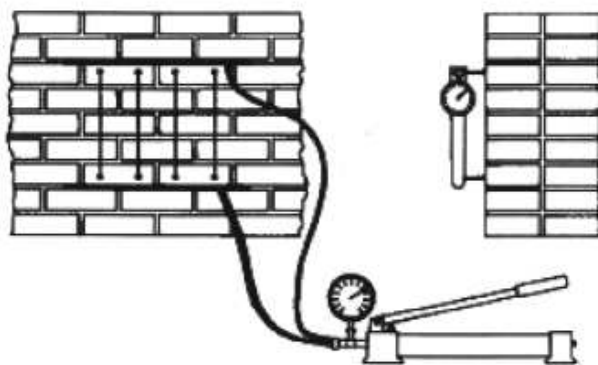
Preparazione della prova ed esecuzione della misura con il deformometro
